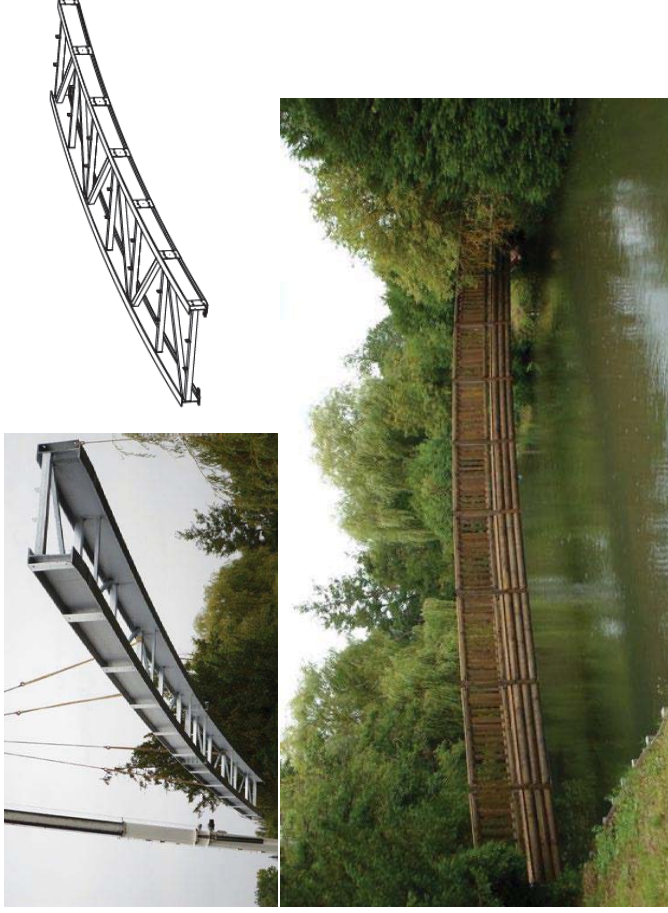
Exemple passerelle structure acier + revêtement bois (source IERTU).
